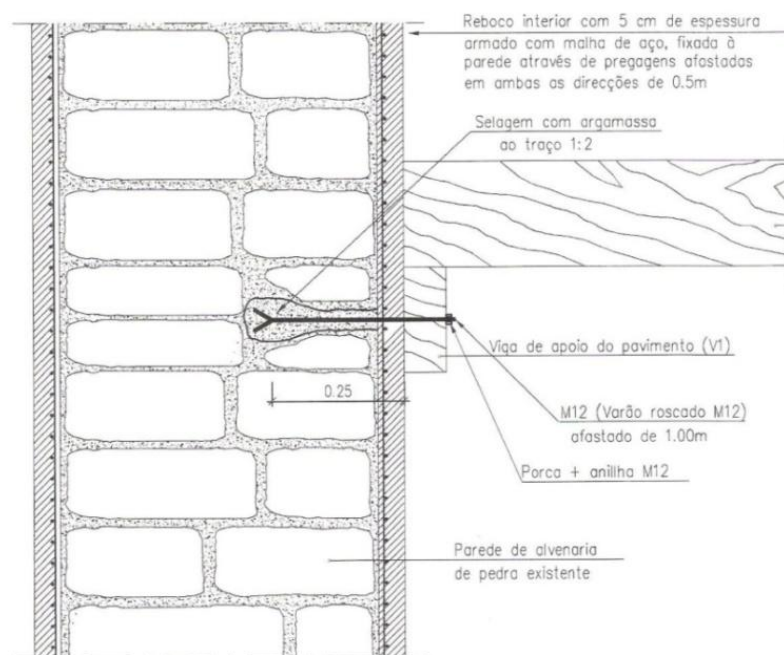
23 Reforço do apoio dos pavimentos nas paredes de alvenaria de pedra, [37].
